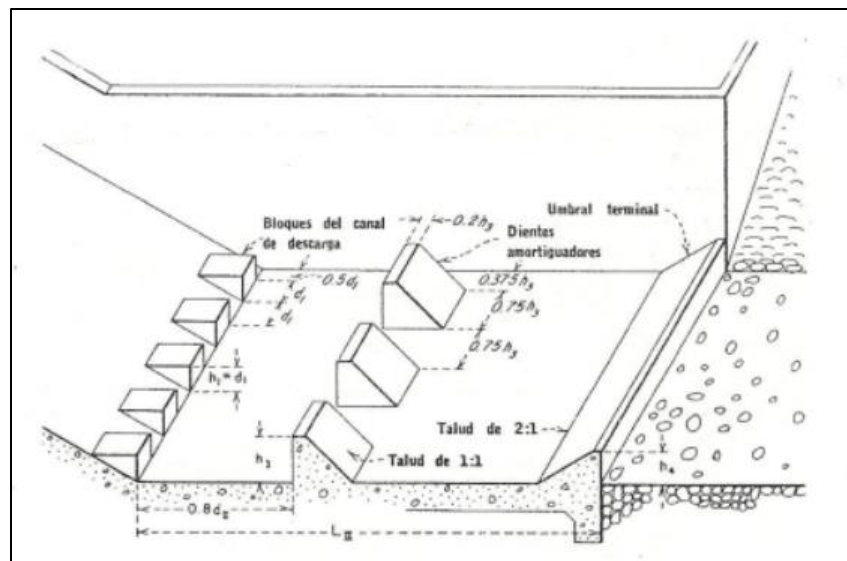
Dimensiones del estanque Tipo II. Diseño de Presas Pequeñas. Pg. 326.
